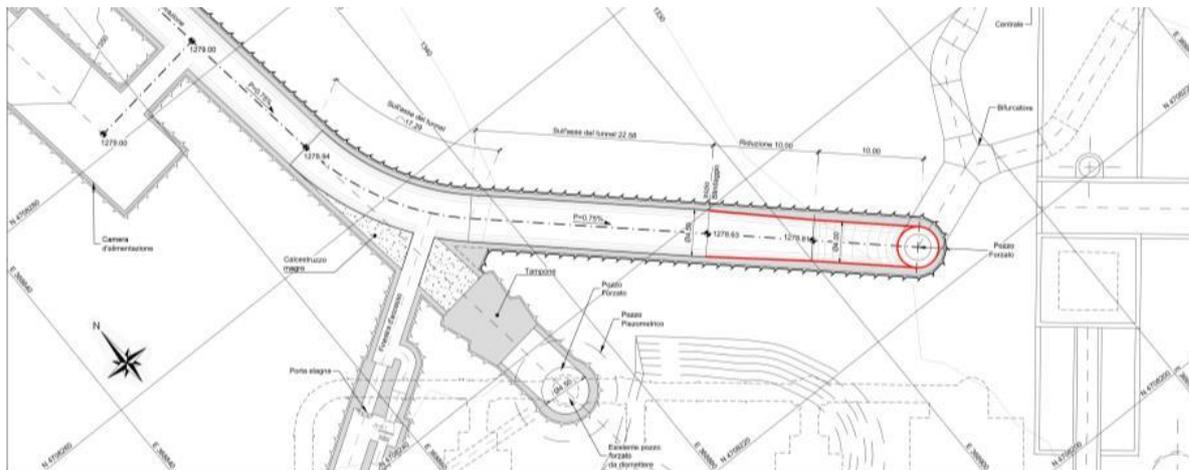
Nuova condotta forzata – planimetria zona superiore (tratto blindato in rosso)
